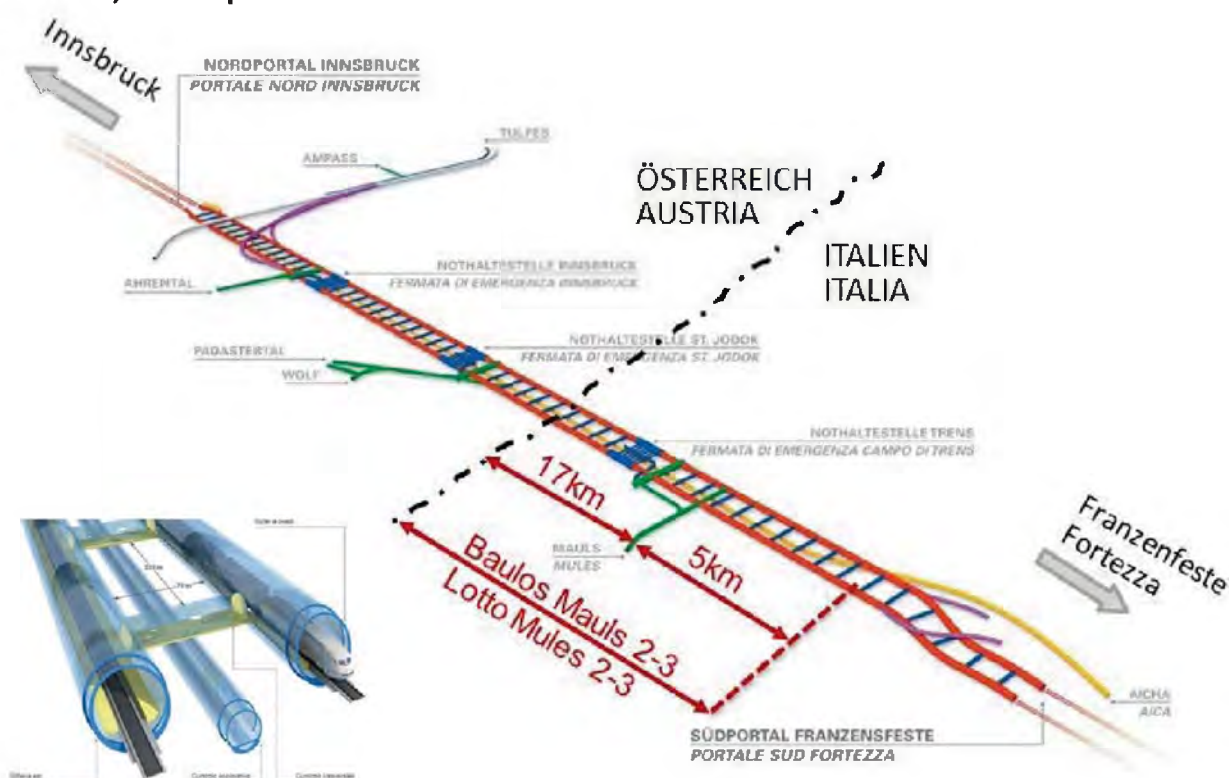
Planimetria schematica della Galleria di Base del Brennero
